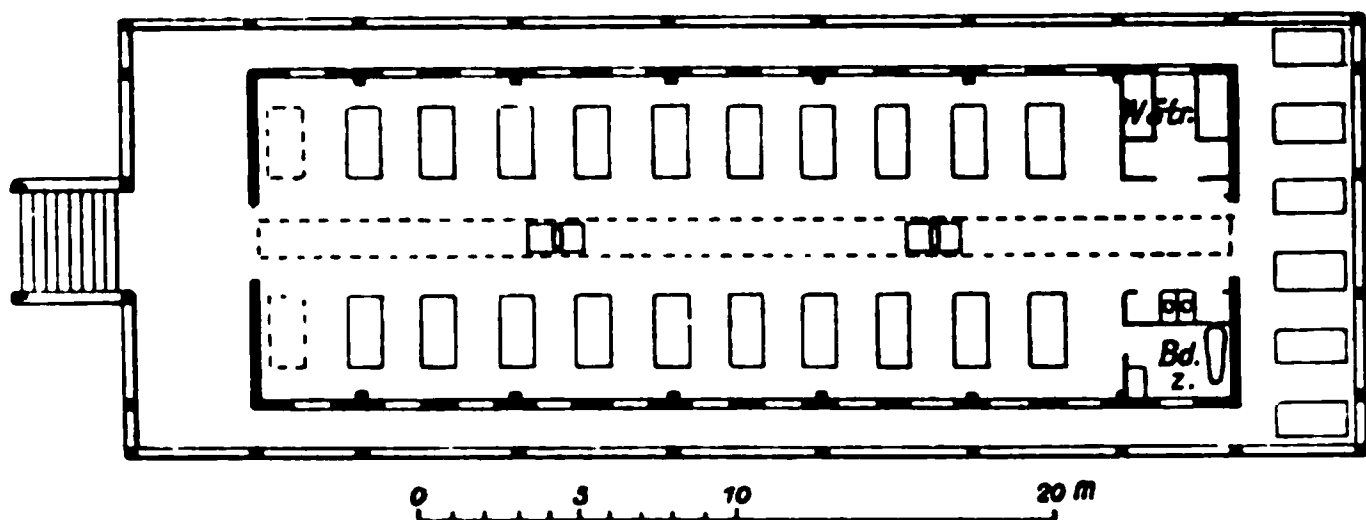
b. Charité-Baracke, Grundriss.
